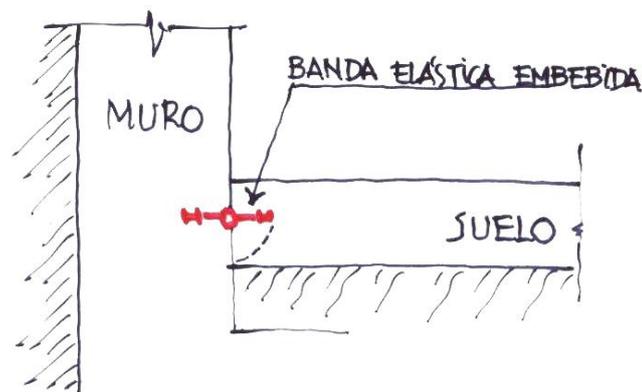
Esquema de encuentro suelo – muro
